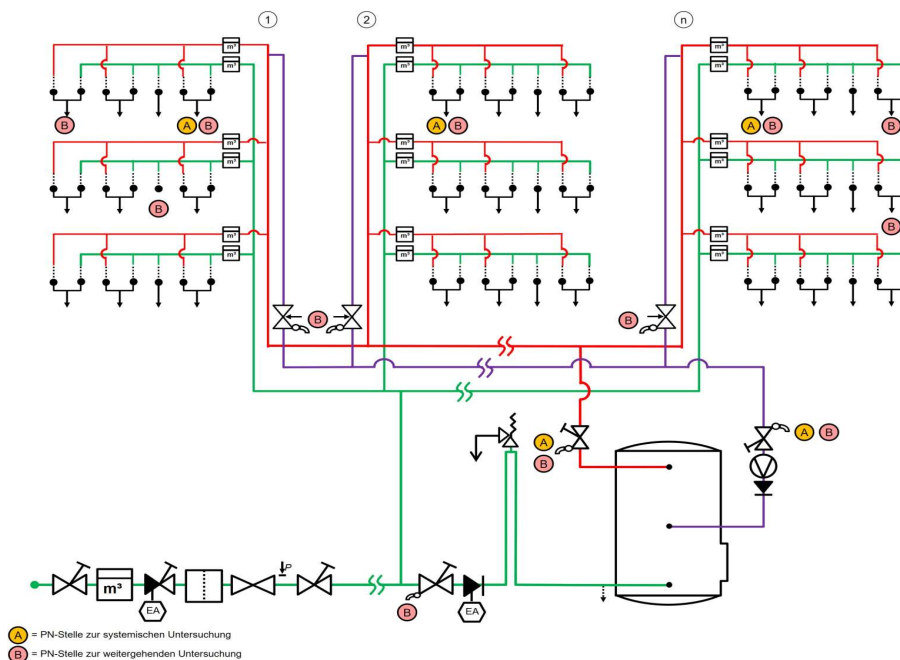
Mit Hilfe von Strangschemas und Grundrissen lassen sich vor Ort geeignete Probenahmestellen festlegen.
